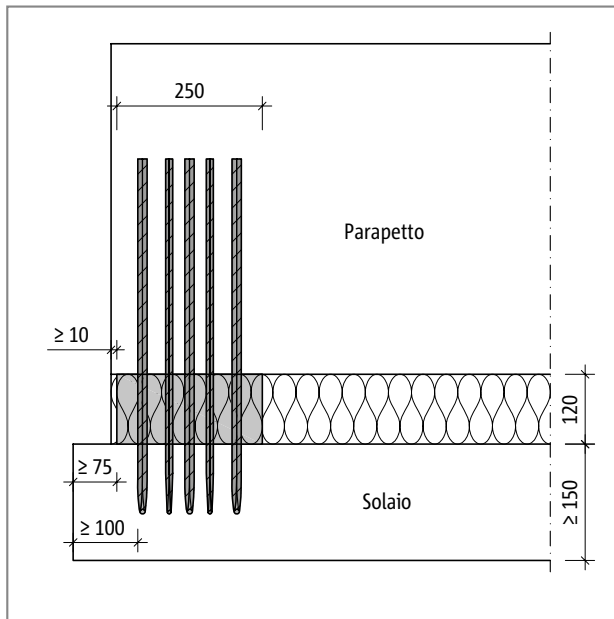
Schöck Isokorb® tipo ABXT - disposizione verticale, distanze tra i bordi
